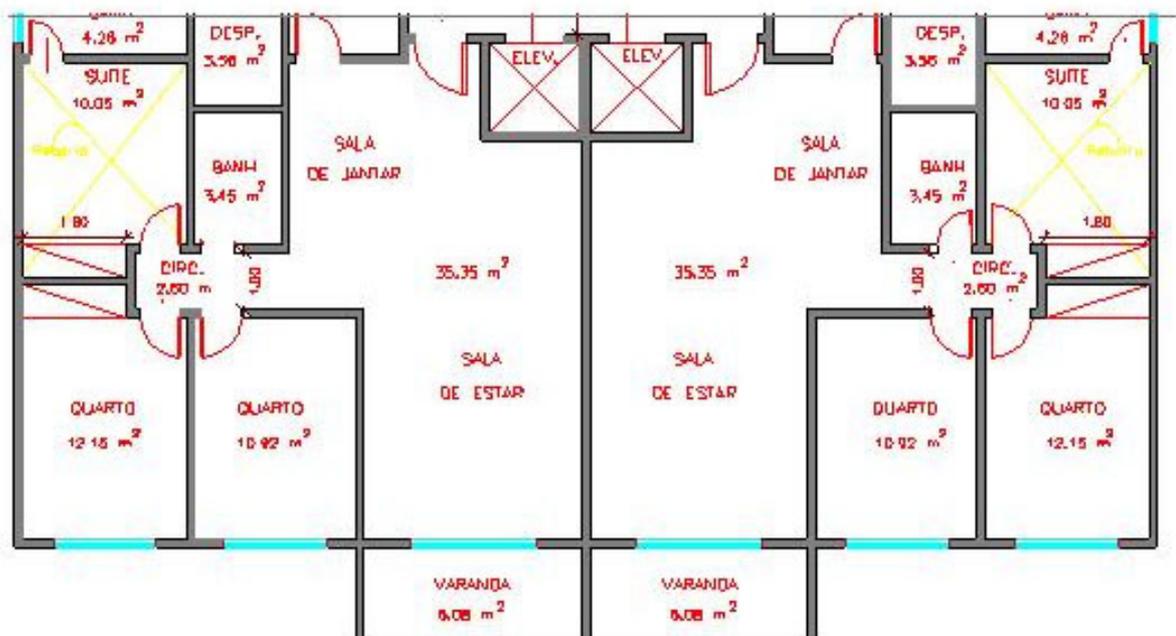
Trecho de uma planta de arquitetura de um pavimento tipo
